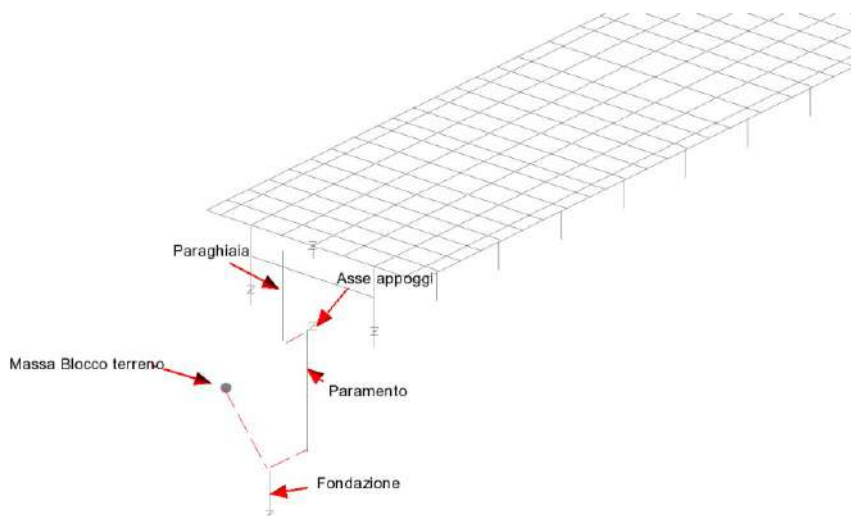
Modellazione spalla - layout E.F.
